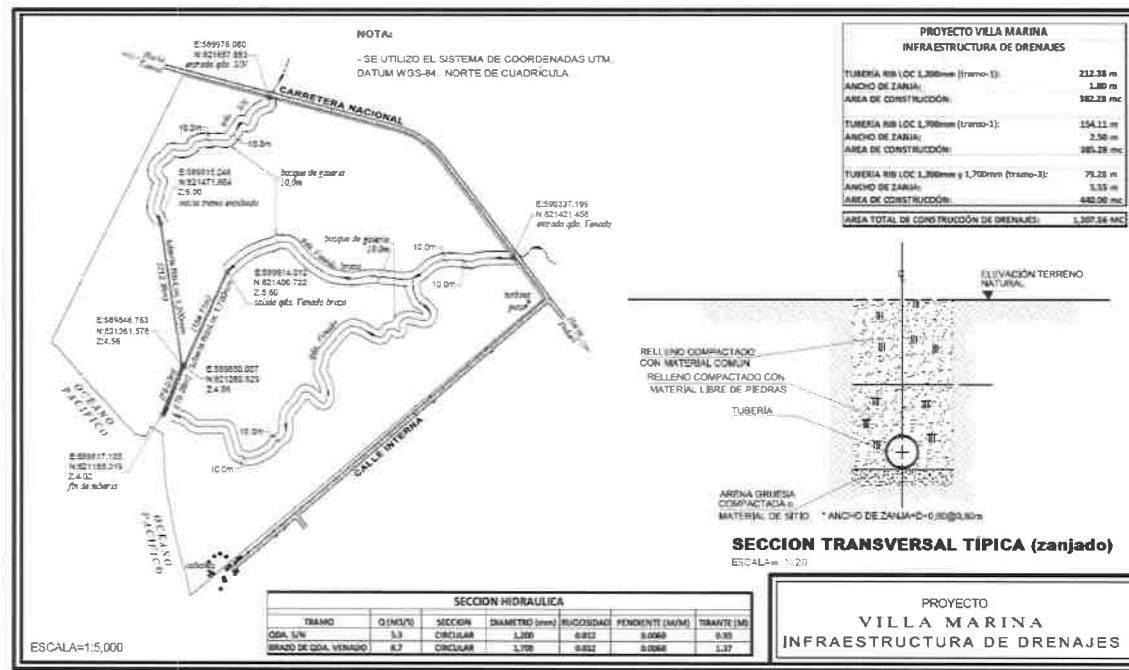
Vista de las infraestructuras de drenaje propuestas. Fuente: Equipo Consultor.
